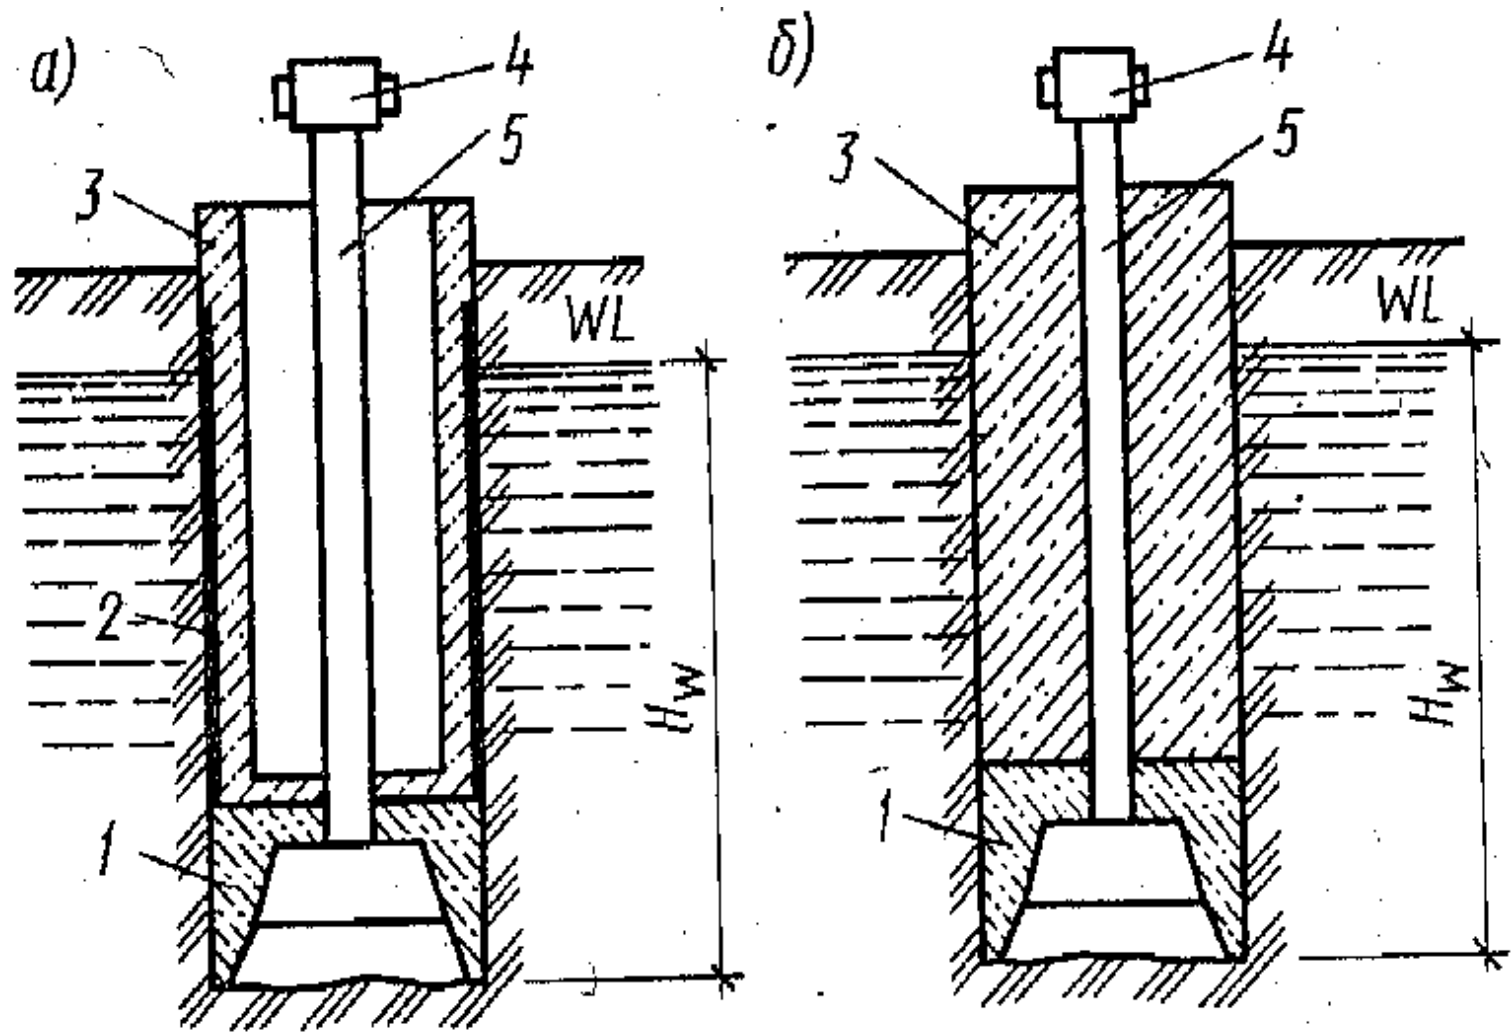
Схема устройства кессона: *а* - заглубленного помещения; *б* - для глубокого фундамента; 1 - кессонная камера; 2 – гидроизоляция; 3 - надкессонное строение; 4 - шлюзовой аппарат; 5 - шахтная труба
